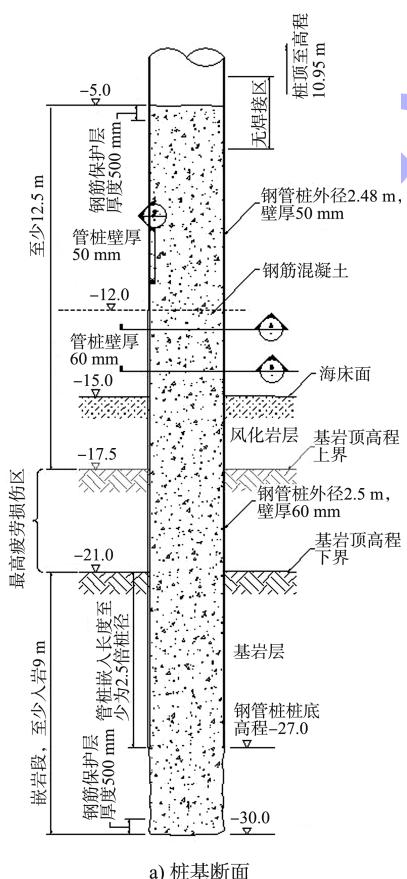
钢筋混凝土芯柱钢管桩设计平面 (高程: m; 尺寸: mm)
